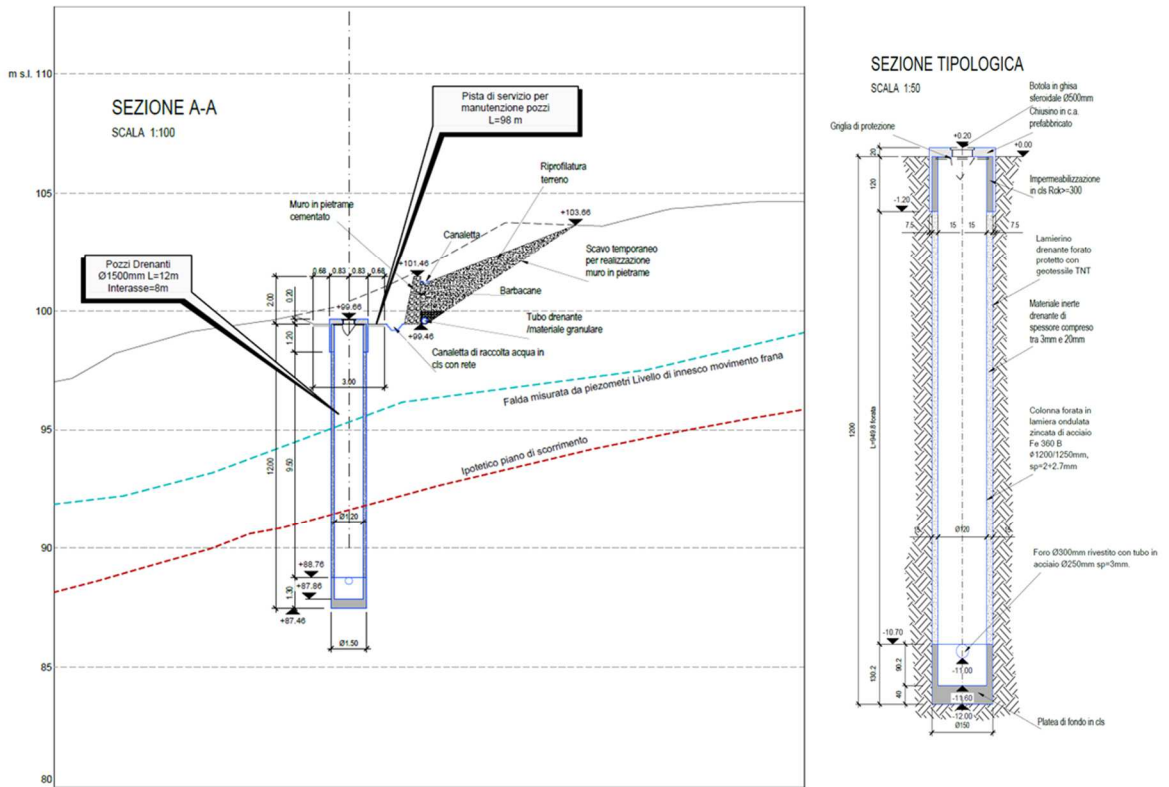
Pozzi drenanti – Dettaglio della pista di servizio e Sezione tipologica
